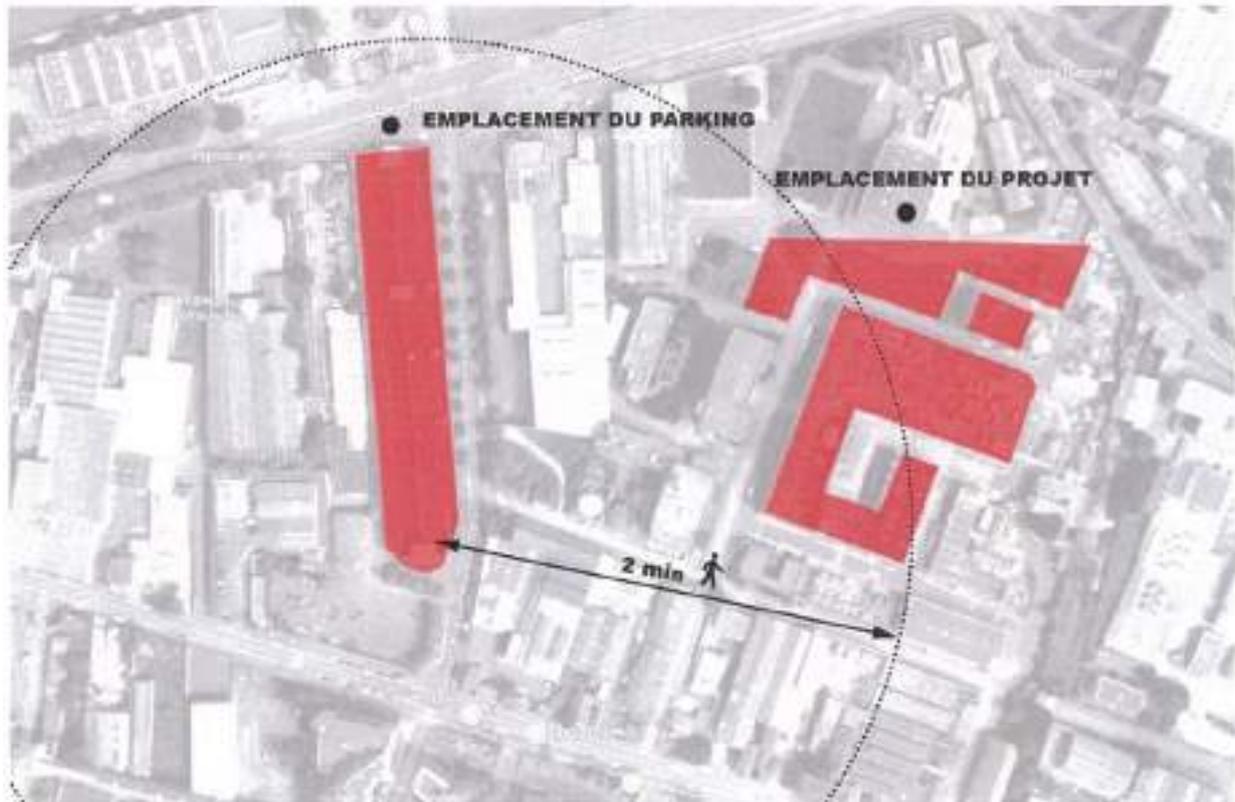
Plan de situation de l'aire de stationnement et du projet
